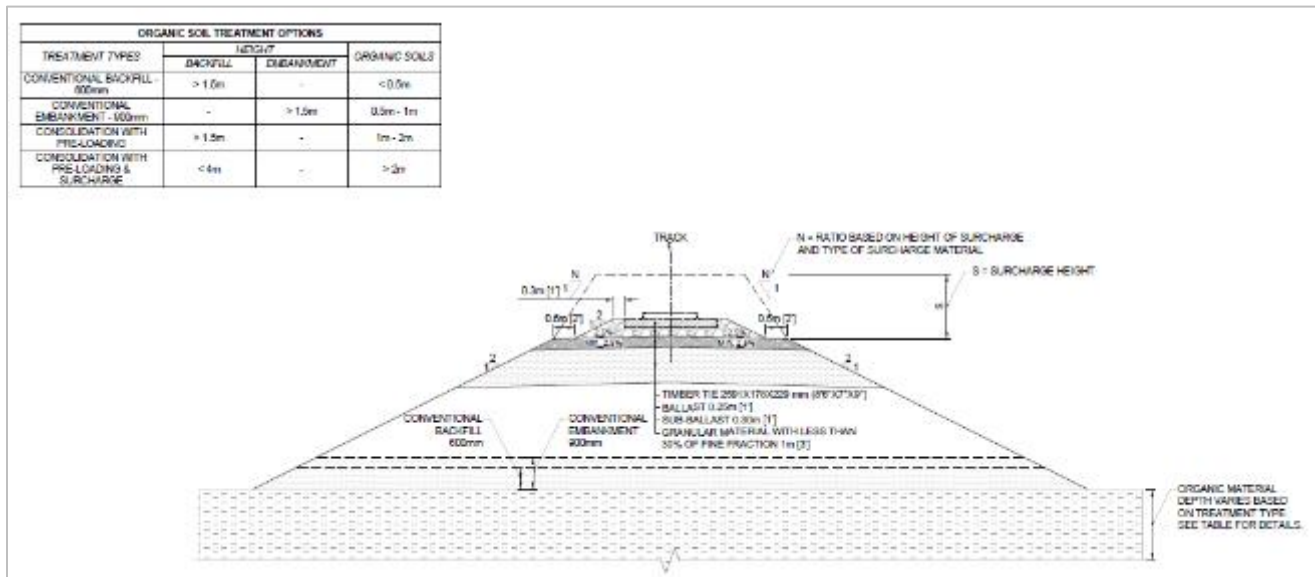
Coupe transversale typique d'une plateforme sur des matériaux compressibles
